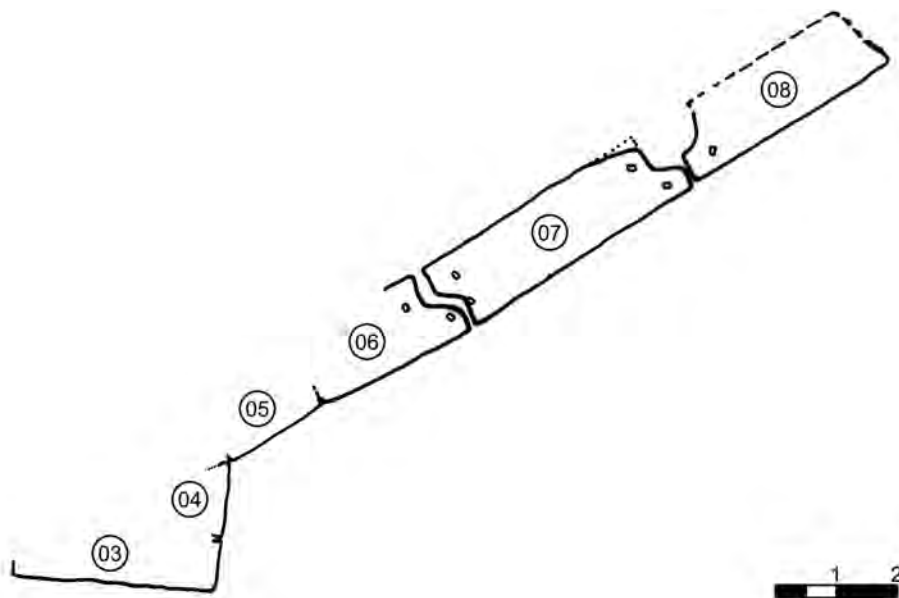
Block 03 bis 08. Grundriss Detail
